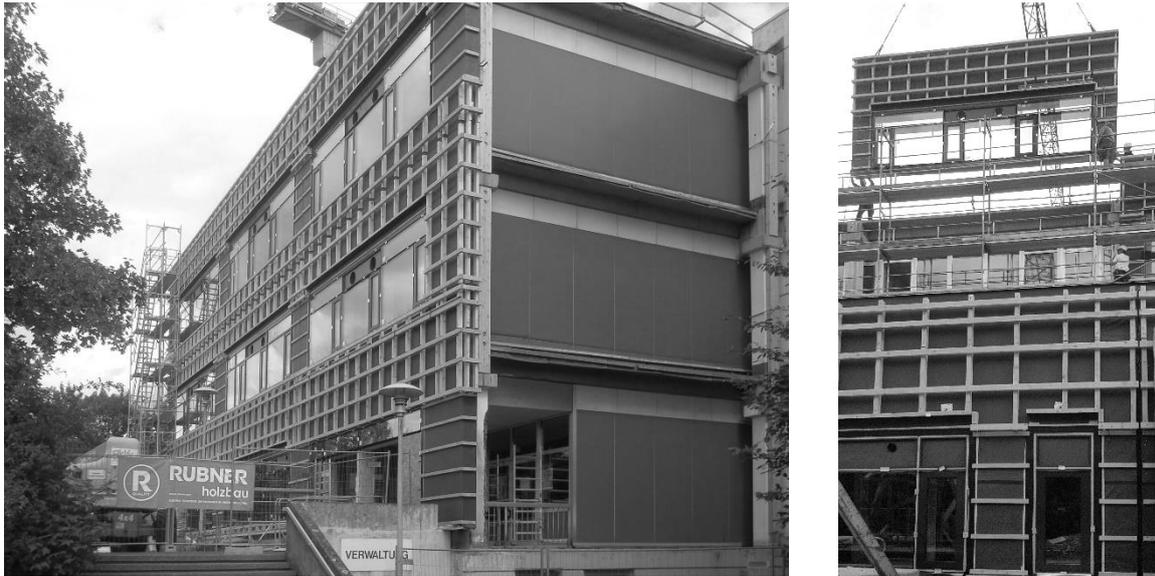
und 6: Fassadenmontage Bauabschnitt 1
